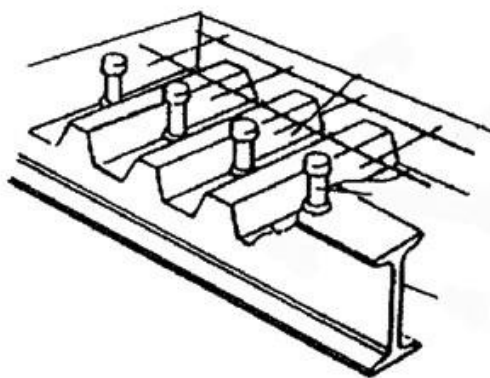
Сталебетонные сборно-монолитные конструкции перекрытий
